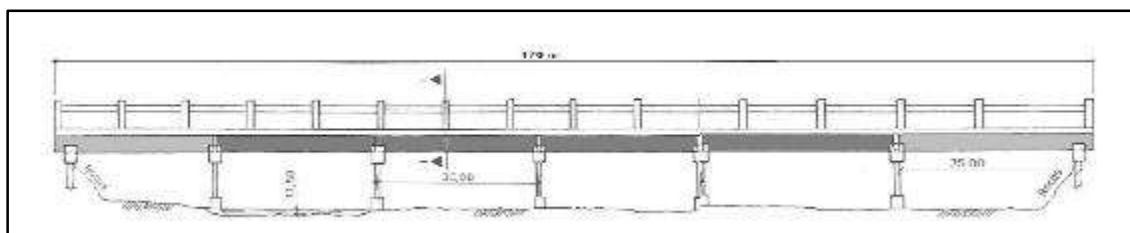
Sección longitudinal del puente sobre el Río Mayarí. Fuente: Ficha técnica del Puente sobre el Río Mayarí. Inventario Nacional de puentes: Informe de inspección, 1986, Vialidad.
